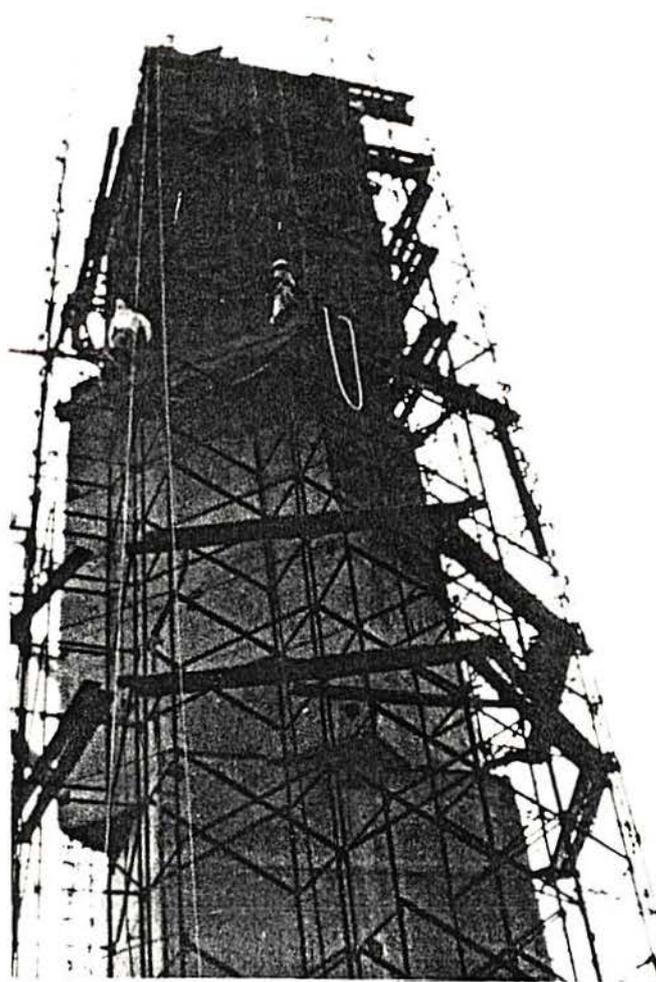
Vista geral de um reservatório elevado durante operação de projeção de argamassa expansiva, para reposição da proteção física das armaduras
